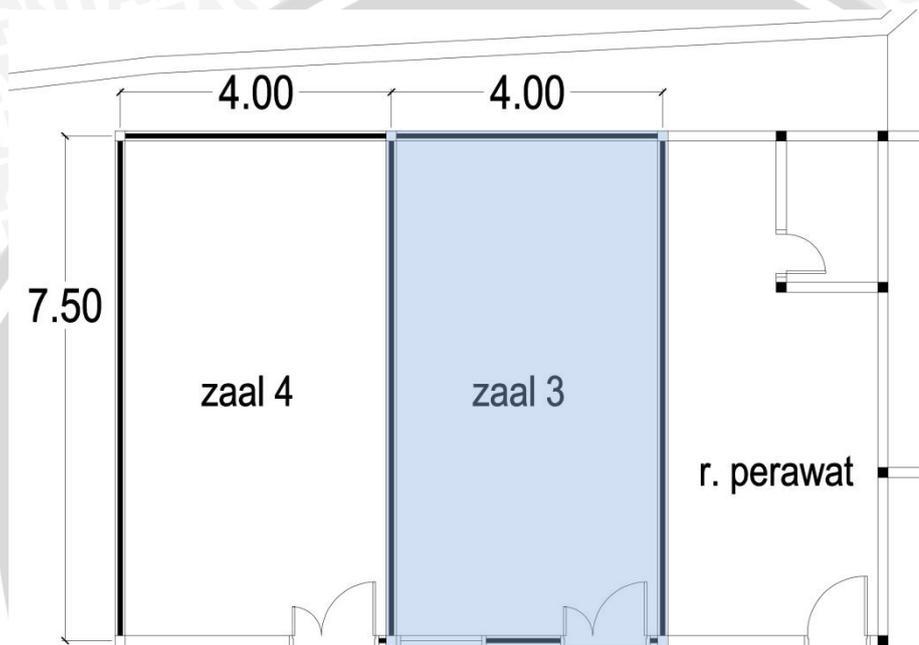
Denah Rumah Sakit Lavalette
